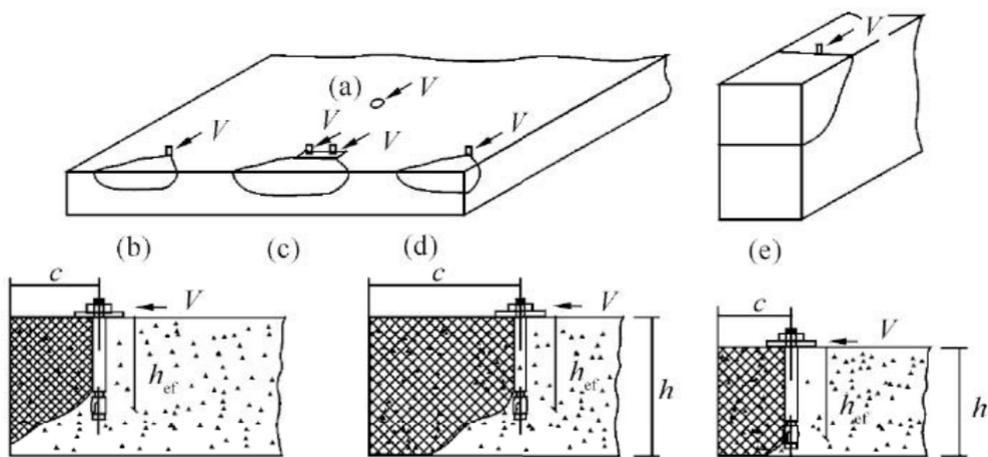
混凝土边缘呈楔形受剪破坏
